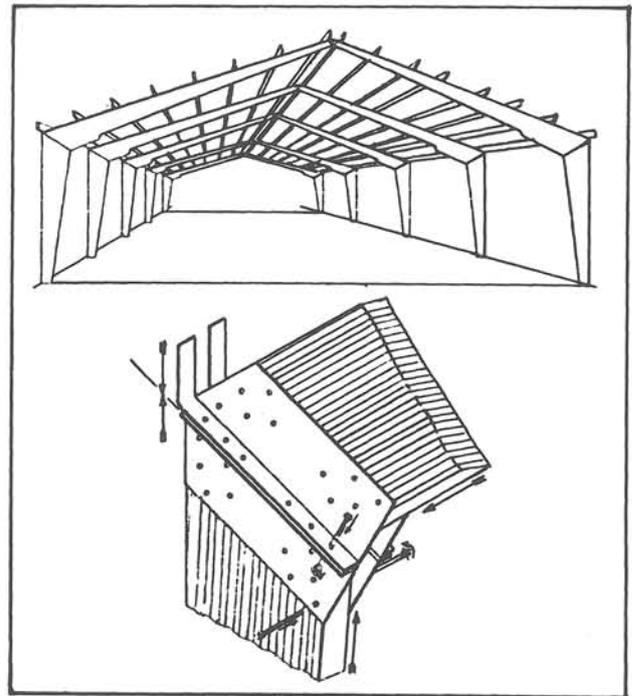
Detalle de ensamblaje en ángulo por uniones metálicas.
